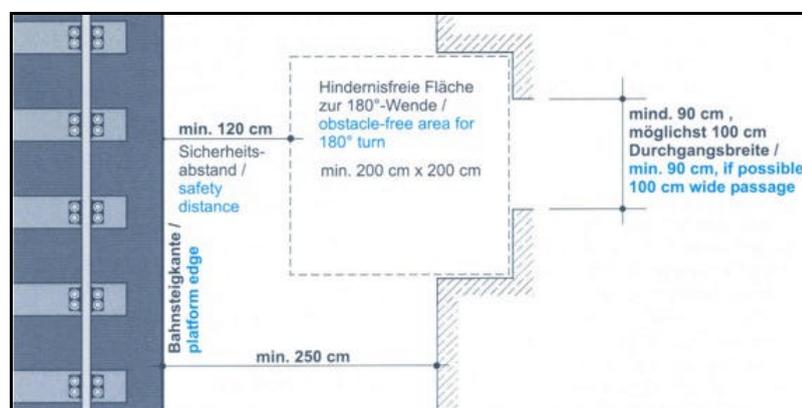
Benötigte Wendefläche eines Rollstuhls [57]
